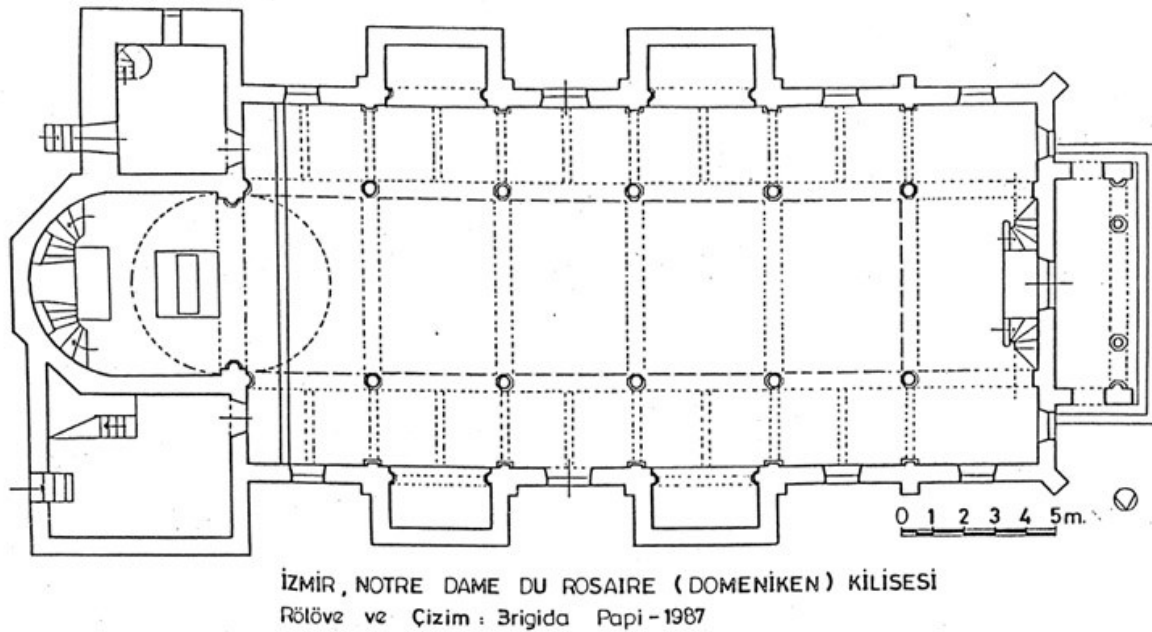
Brigida Papi, Pianta della chiesa del santissimo Rosario, Biblioteca dell'Università dell'Egeo, Smirne.
